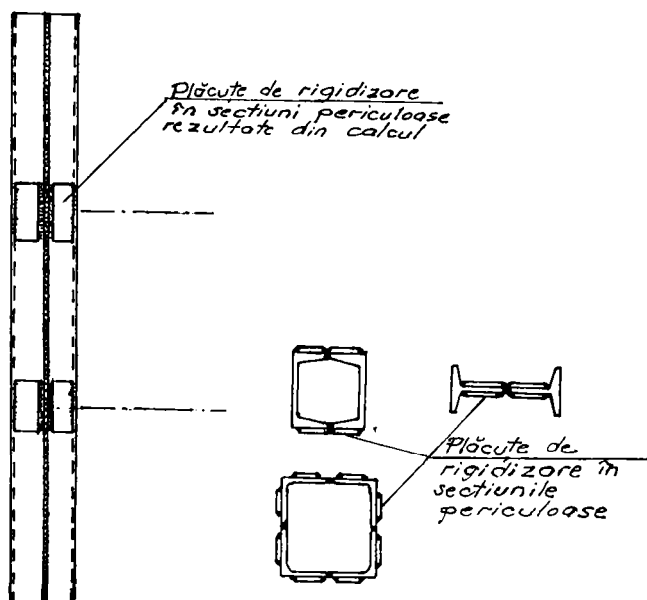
Detalii constructive de alcătuire a barelor cu conlucrare
